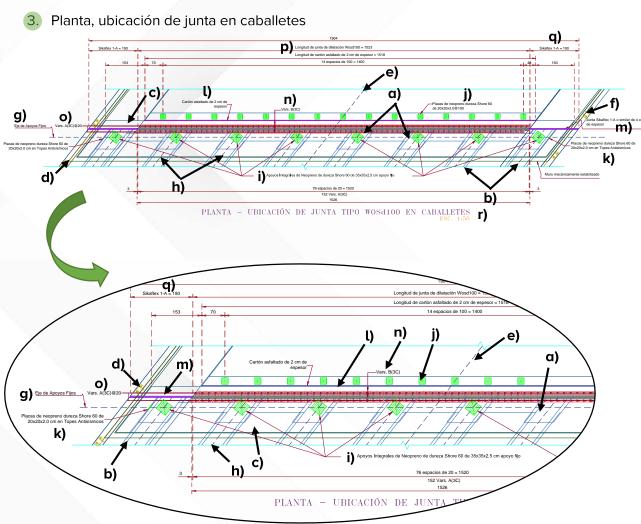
Ejemplo planta, ubicación de junta en caballetes
